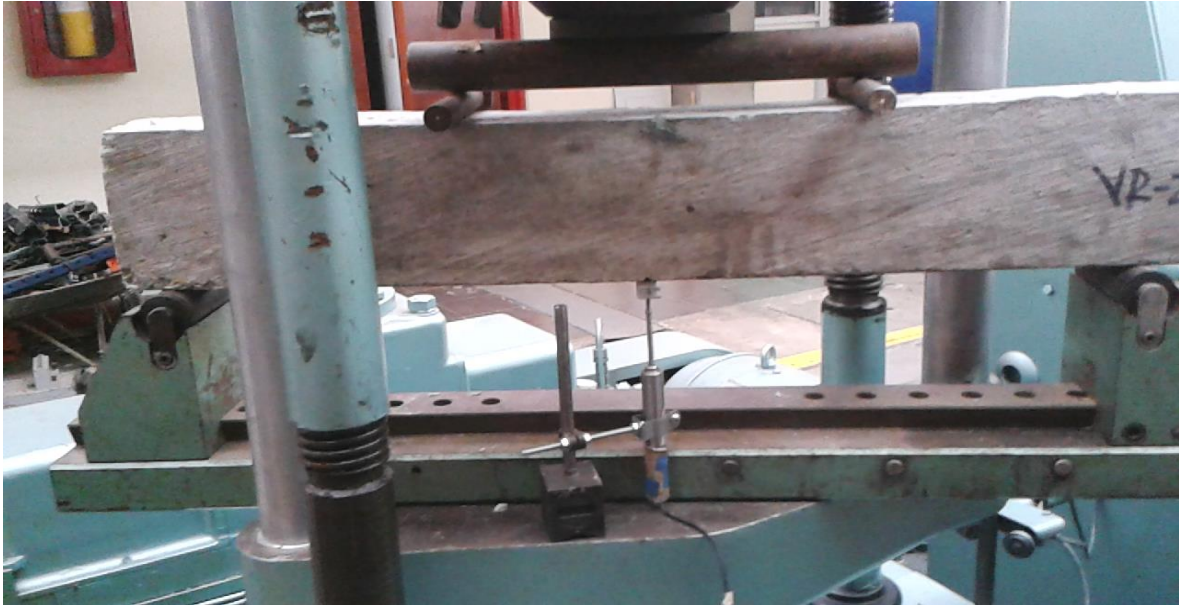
Viga VR-2 al inicio de la prueba
